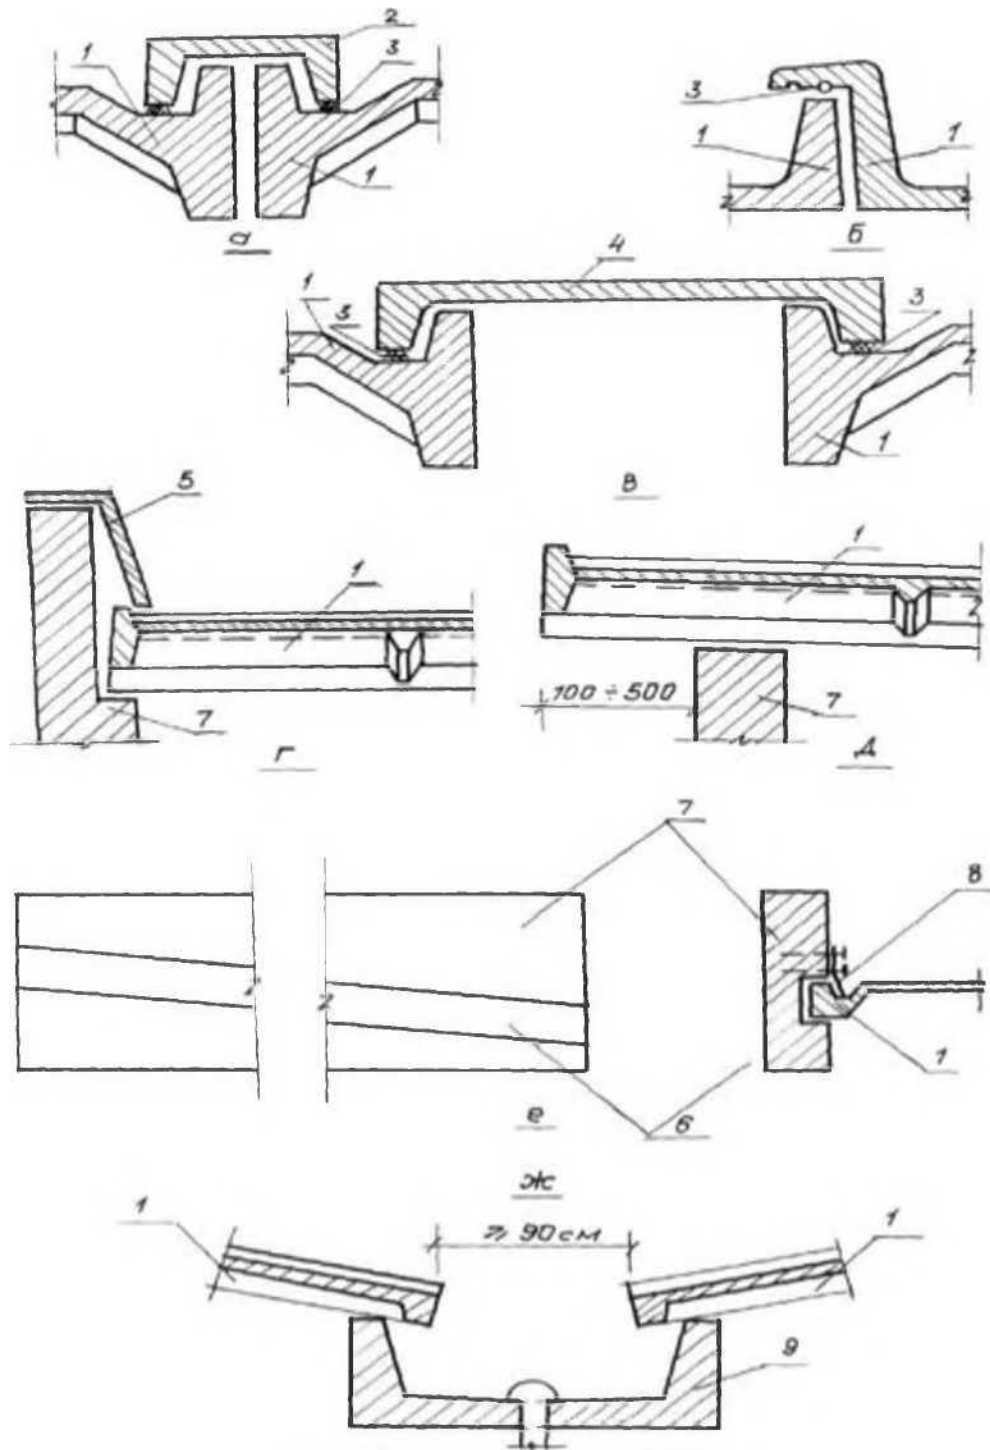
Схемы стыков и примыканий сборных железобетонных кровельных элементов
